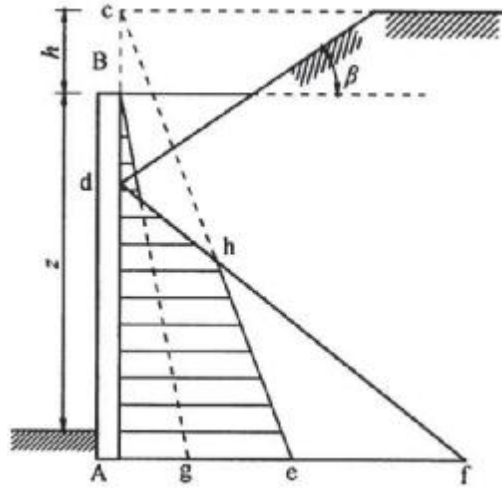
地面中部为斜面时支护结构上主动土压力的近似计算
